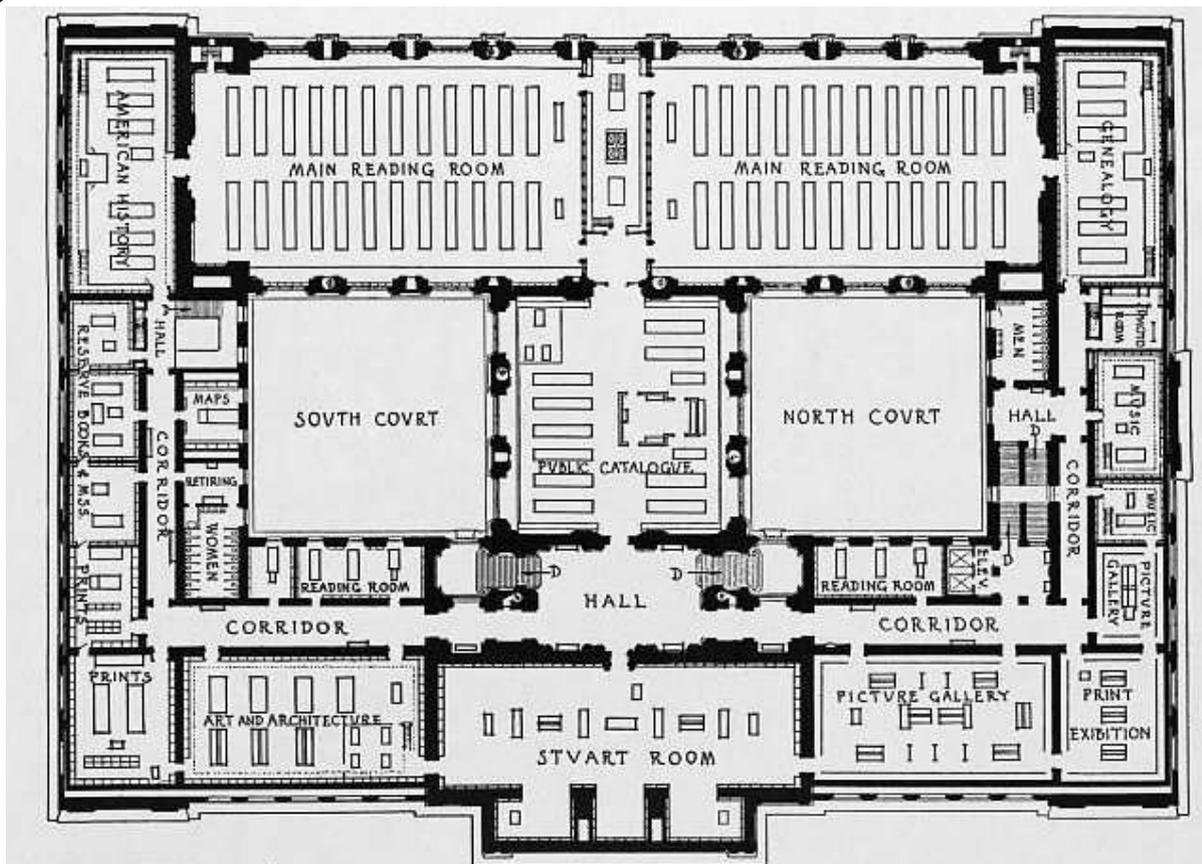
Grundriss der New York Public Library, 1911
